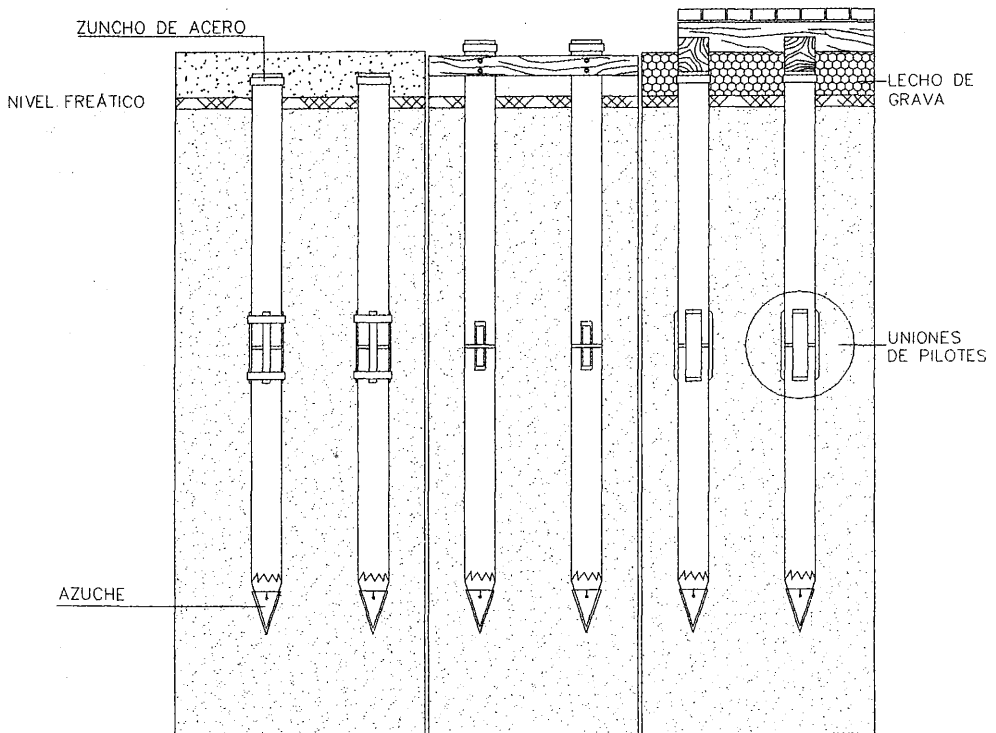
Cimentación profunda tradicional mediante pilotes de madera y encepado superior.
